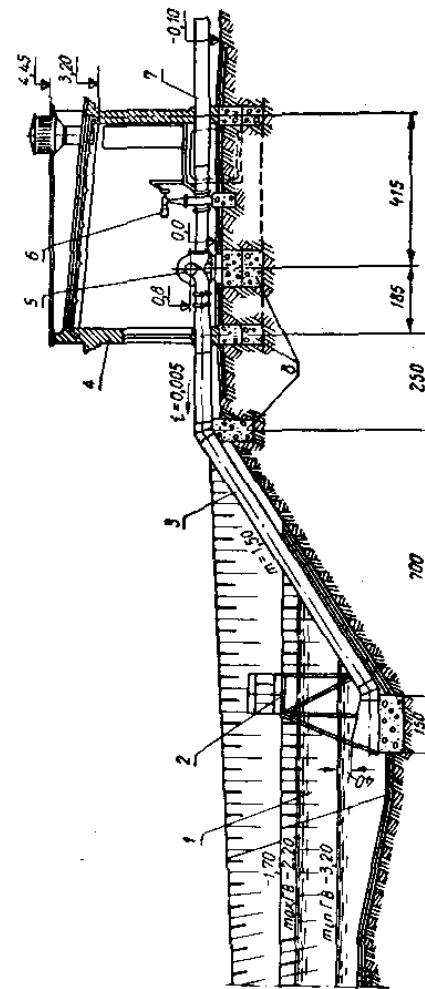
Незаглубленное и раздельное здание станции на ленточном фундаменте:
